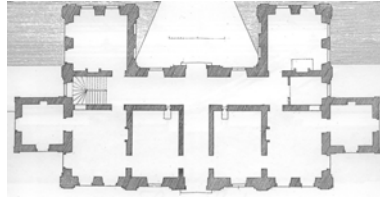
Grundriss, Ausschnitt aus einem Blatt von J.B. Broebes 1706
